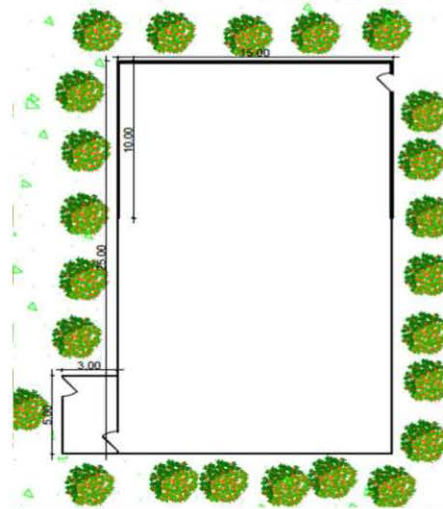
Planta arquitectónica de jaula para rehabilitación de aves medianas.
